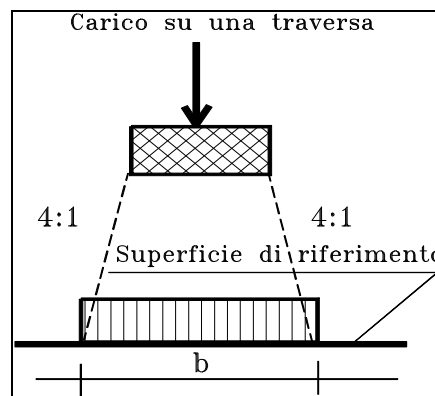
Distribuzione longitudinale dei carichi attraverso il ballast.
